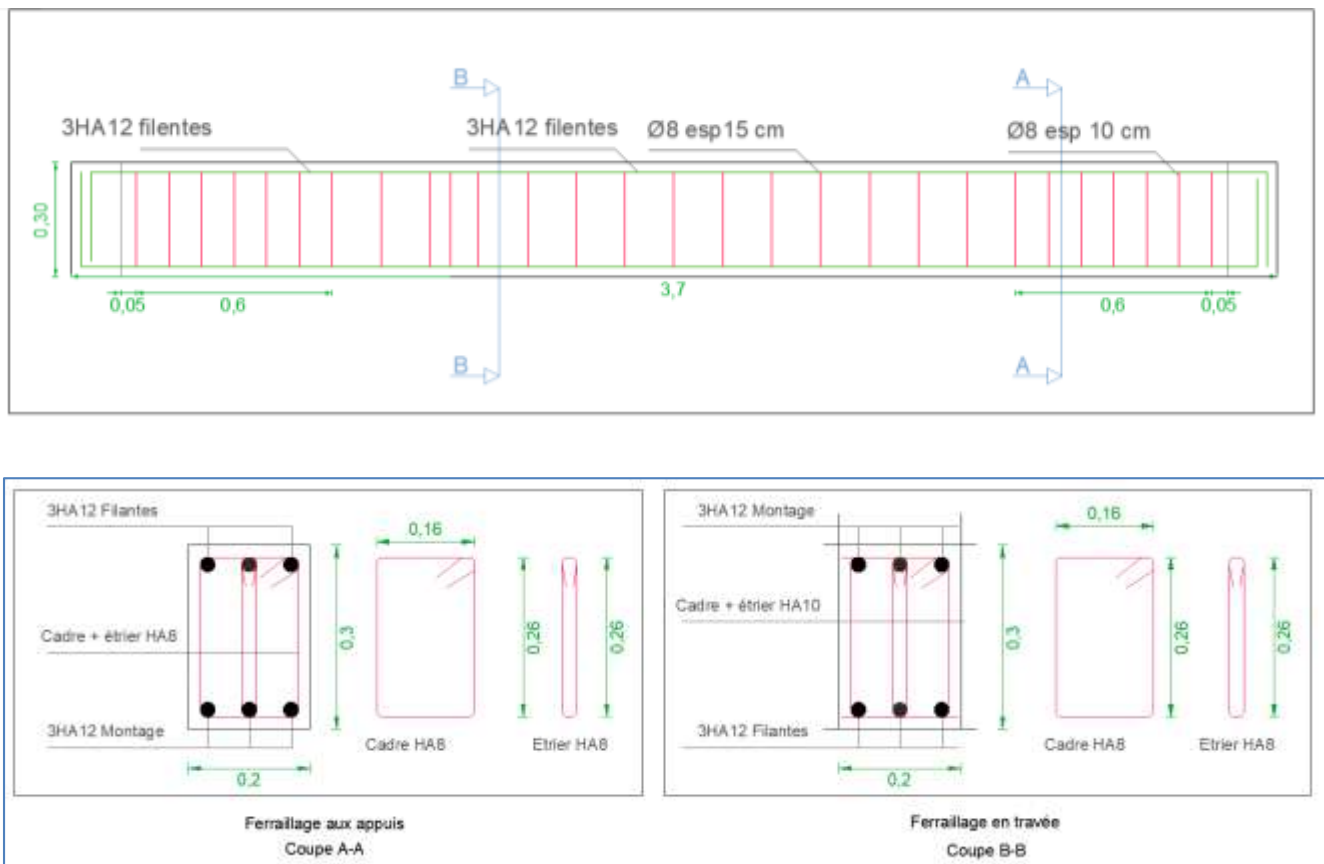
Schéma du ferrillage de la Poutre de chaînage
